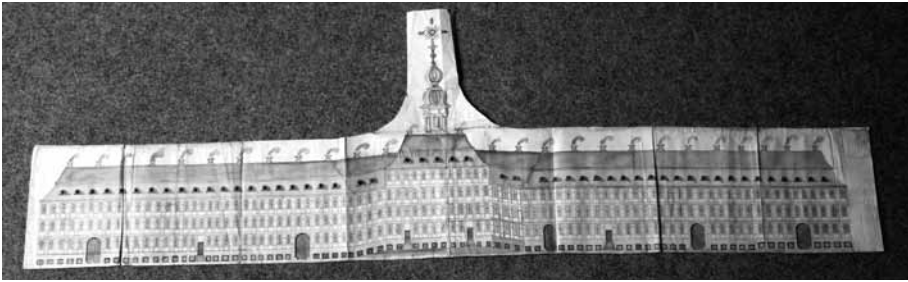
Plan eines Hildesheimer Barockschlusses, undatiert (17. Jahrhundert)
